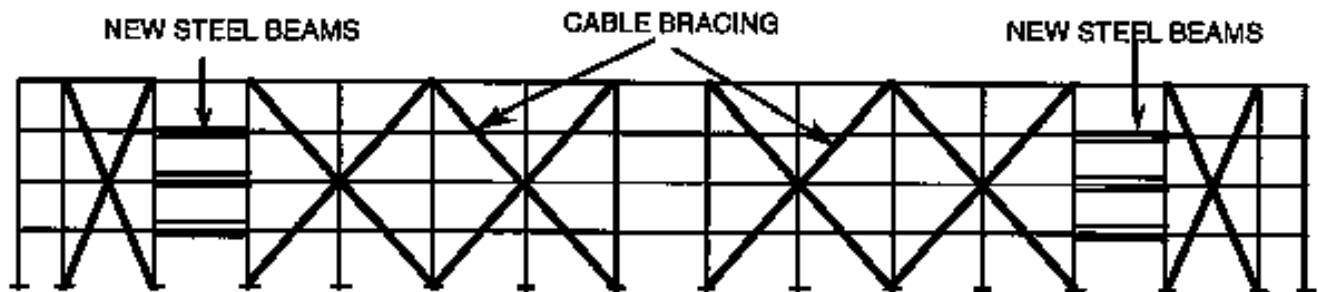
Acomodo de los cables utilizados para reforzar el edificio. (Aguilar, F. Breña, Jara, Iglesias, & Picado, 1996)
